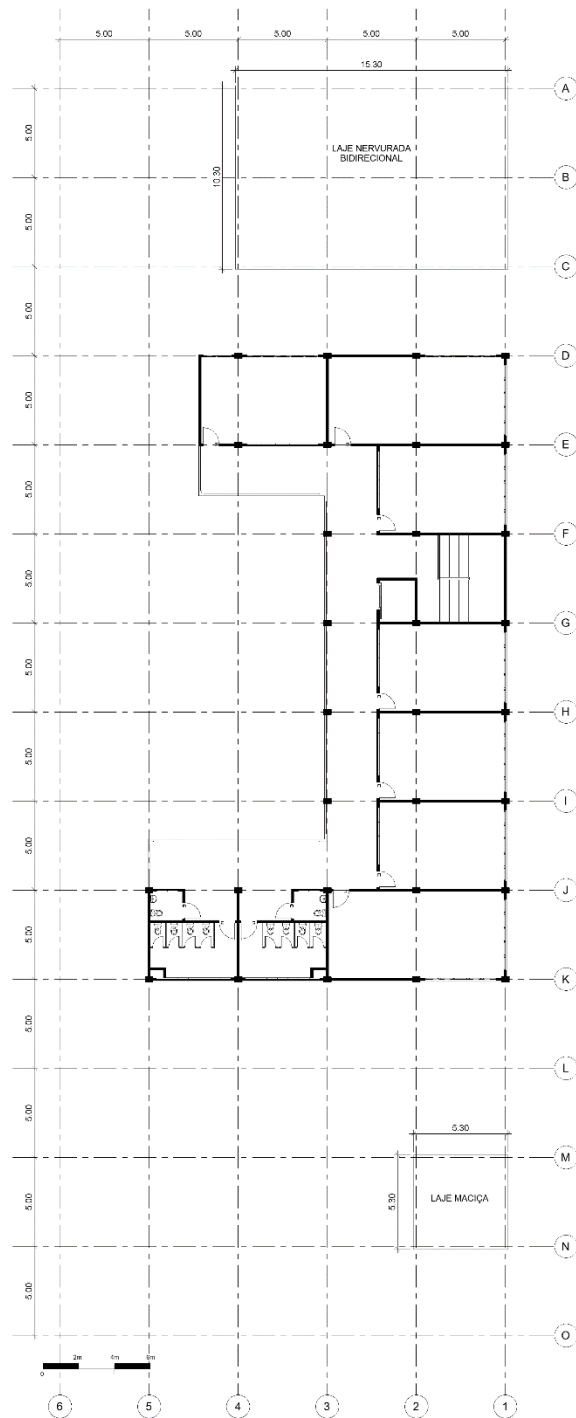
Eixos Estruturais Térreo – Centro Comunitário
